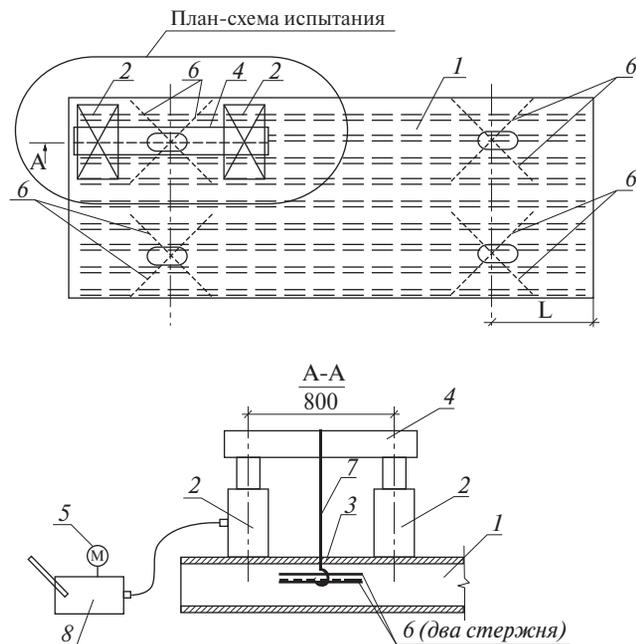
Схема испытания (ГОСТ 8829–94) подъемного крестообразного захвата (КП): 1 – плита; 2 – гидравлический домкрат грузоподъемностью 10 т; 3 – захватный крюк Ø24 А1; 4 – металлическая балка; 5 – манометр; 6 – арматурные стержни подъемного крестообразного захвата; 7 – тяга; 8 – насосная станция (подключается к двум домкратам)
